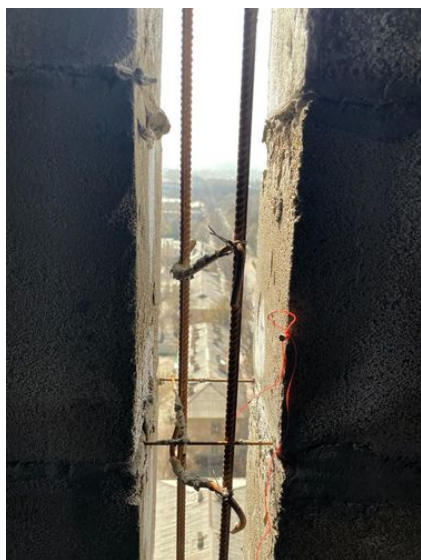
Обрушение ограждающей стены из пенобетонных блоков строящегося 15-этажного дома в г.Бишкек
